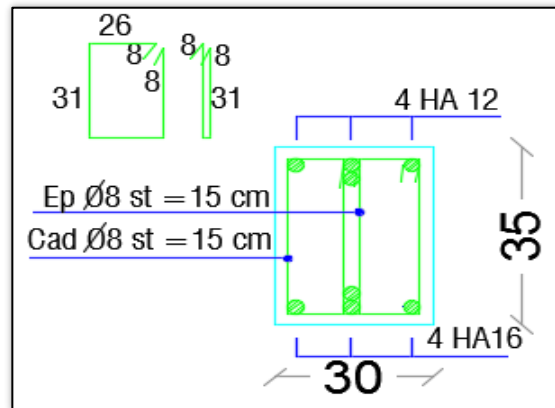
Schéma de ferrailage de la poutre selon CBA93
